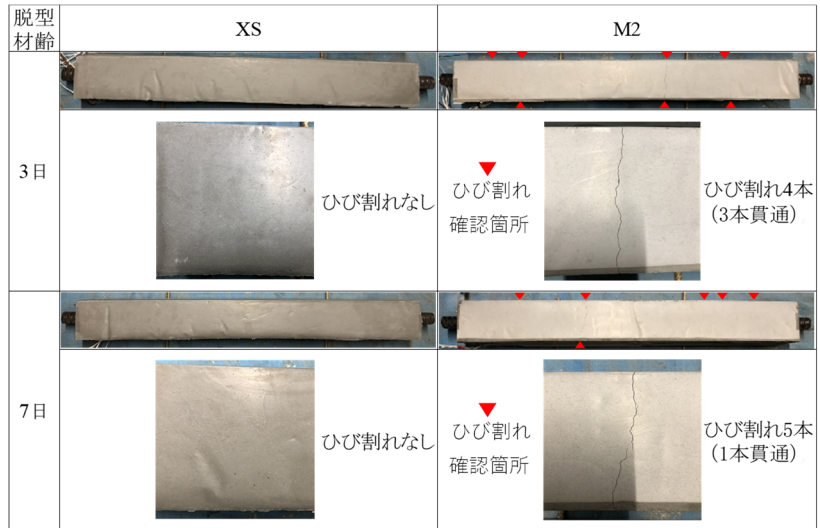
乾燥材齢1年 鉄筋拘束試験体のひび割れ状況
